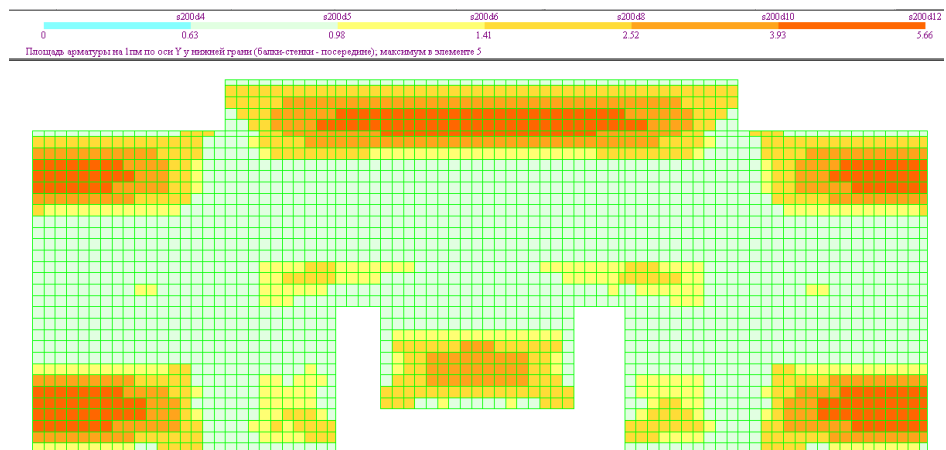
Подбор нижней продольной арматуры плиты по оси Y
